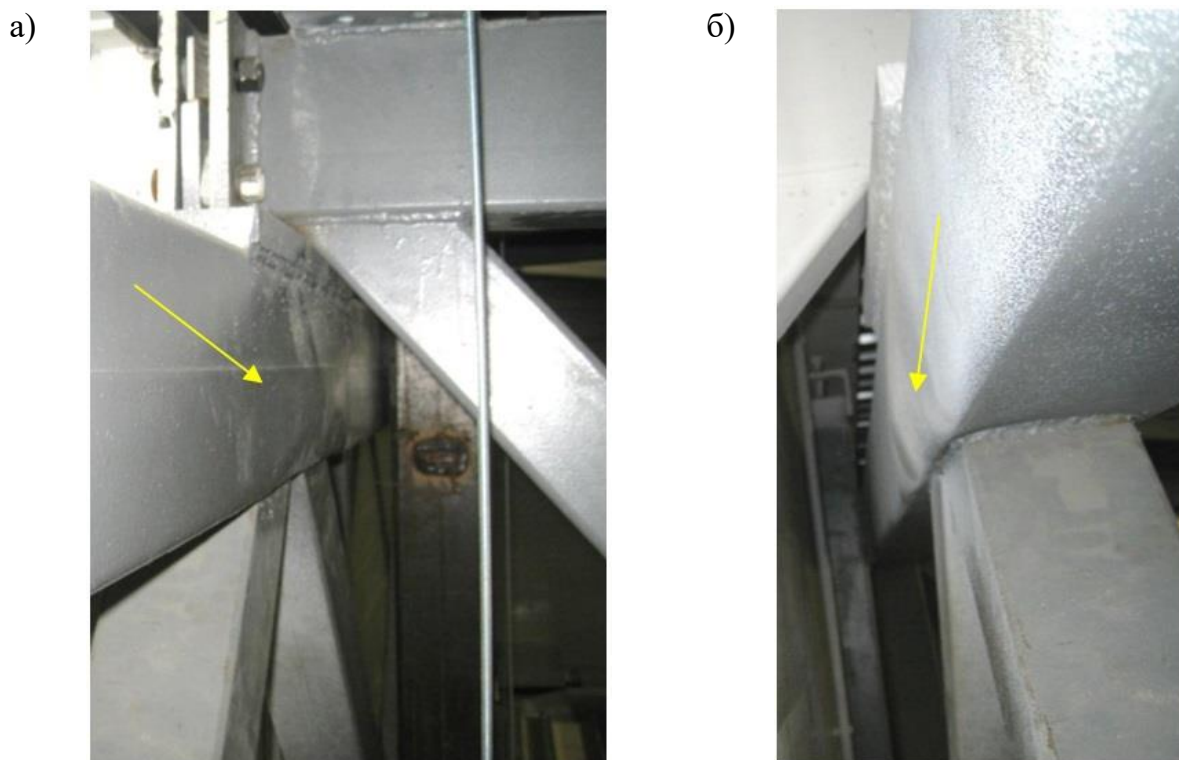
Потеря местной устойчивости стенок сечения верхнего пояса подстропильной фермы ПФ Б 1-2 в месте опирания стропильной фермы Ф А-Б- 1/2 со стороны пролета А-Б (а) и со стороны пролета Б-В (б)
